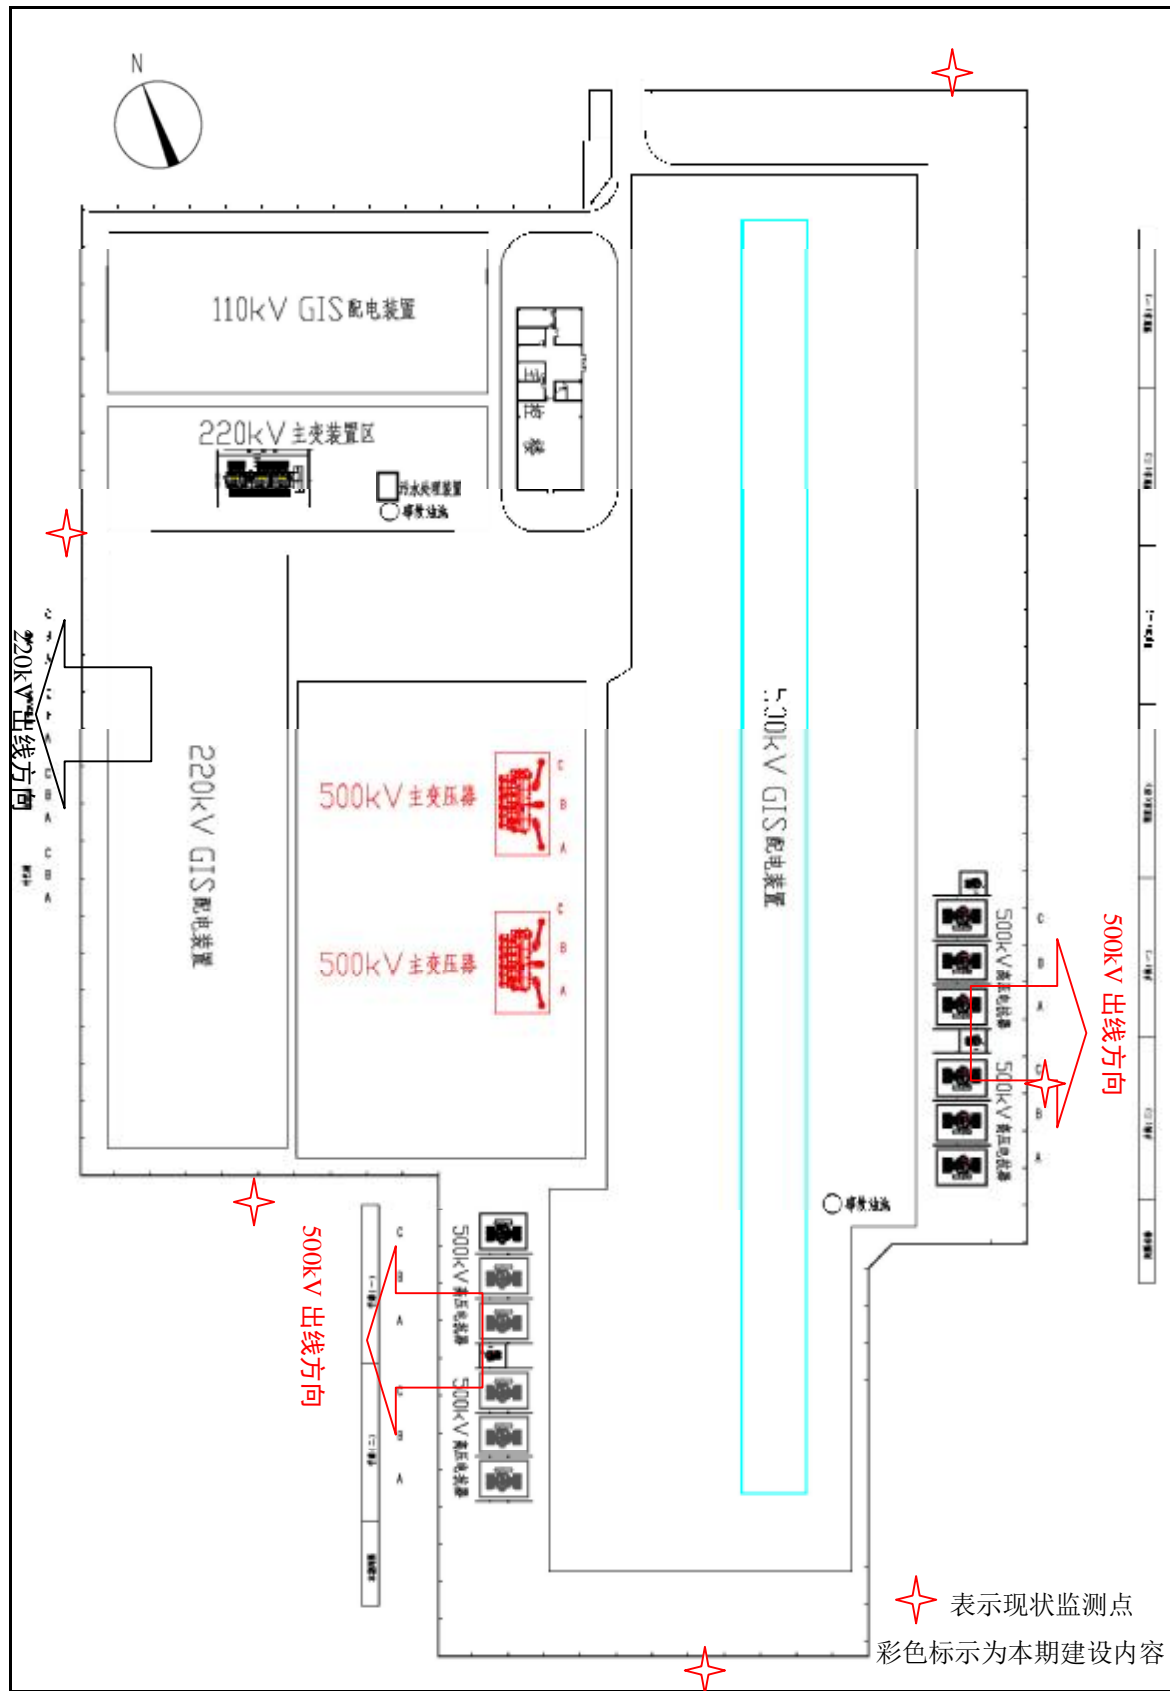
巴塘 500kV 变电站站区总平面布置及监测点位布置图
